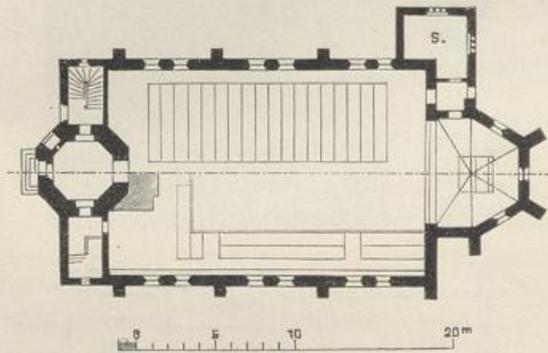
Grundrisse zu ebener Erde und in Emporenhöhe.
